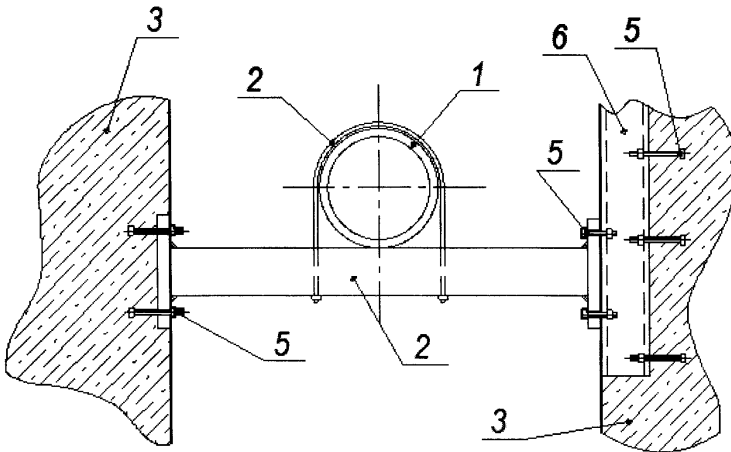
Пример назначения границ между опорными конструкциями и строительными конструкциями
